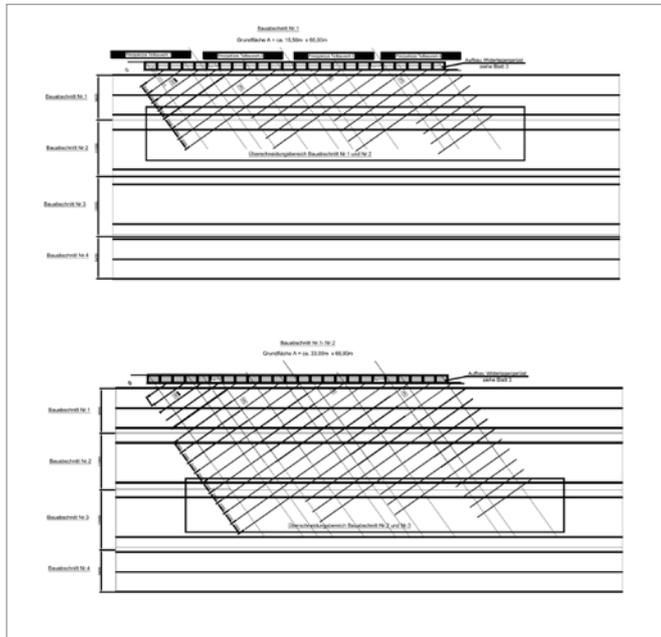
Grundriss der Montageabschnitte über der Autobahn A40, Quelle: Ingenieure Tomshöfer & Partner, Bochum
